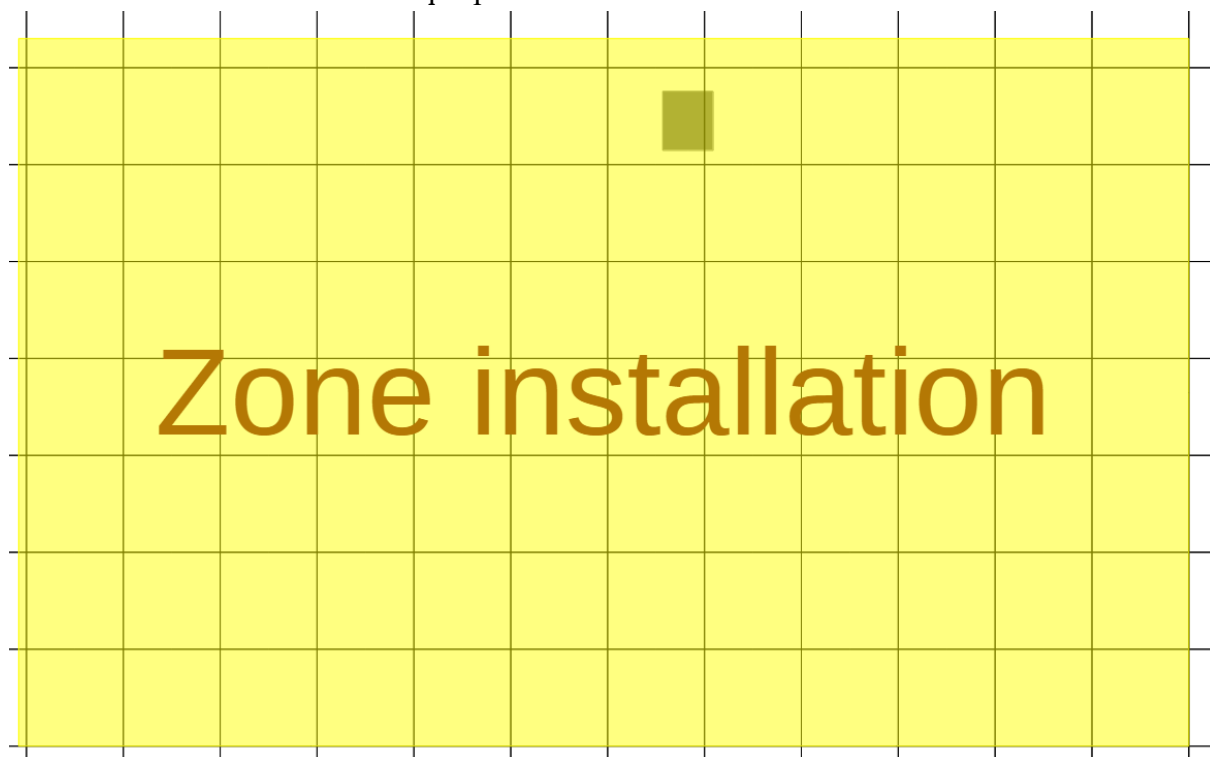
Extrait du plan de la salle d'ordinateurs de l'IDRIS avec la zone pressentie pour l'installation du CUBE
